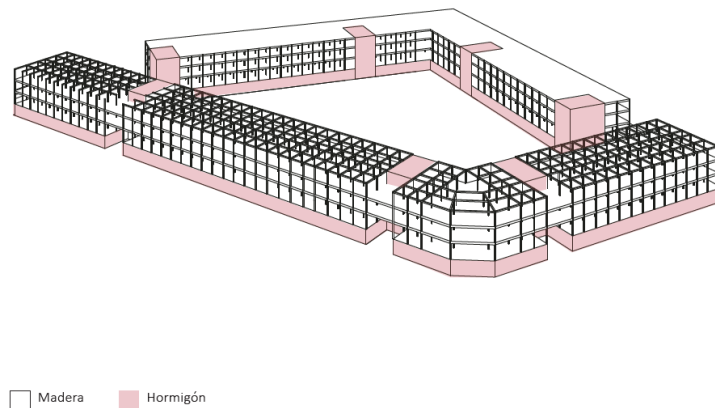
Sistema constructivo del proyecto VIP en la comunidad de Renca
